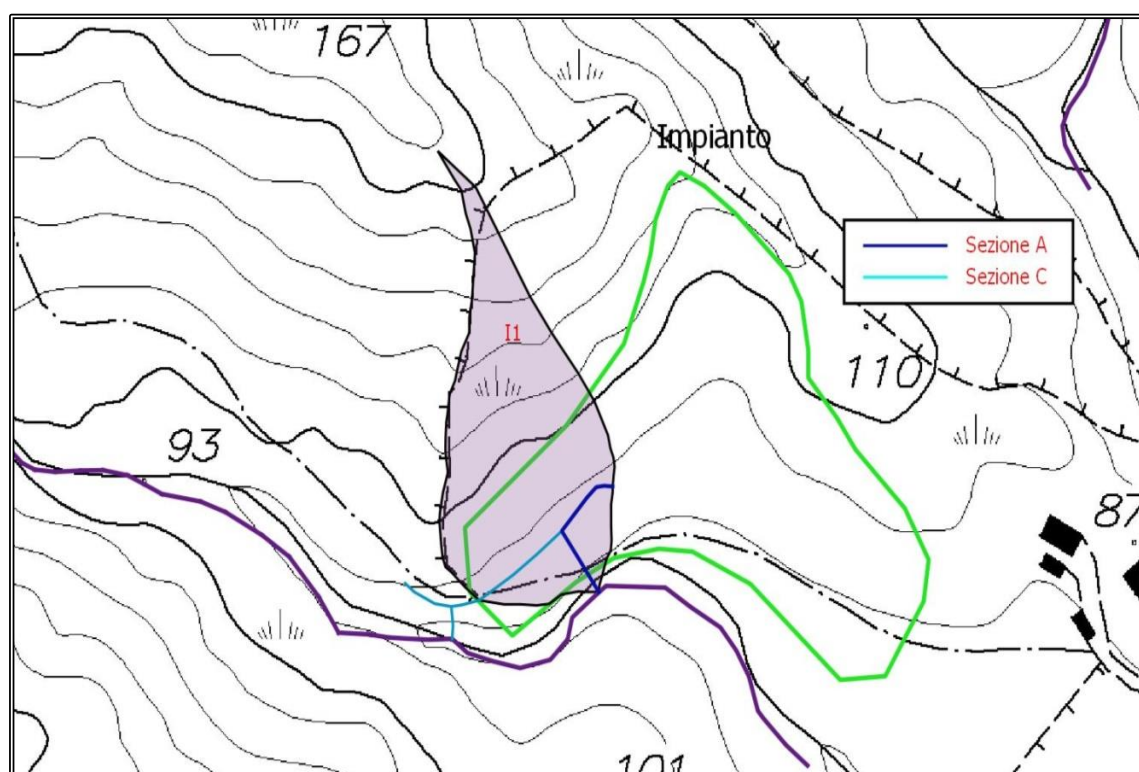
Schema della rete di drenaggio, con tipologia di sezione trasversale di progetto (Area Impianto I1).
